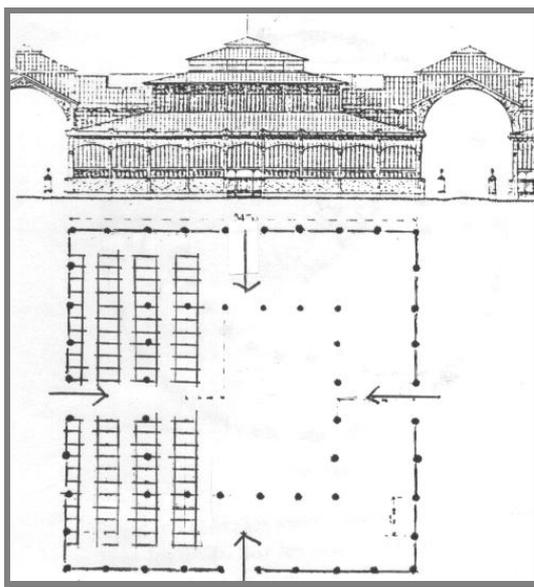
Halles* Planta de um Pavilhão. Fonte: Cloquet, 1900.
